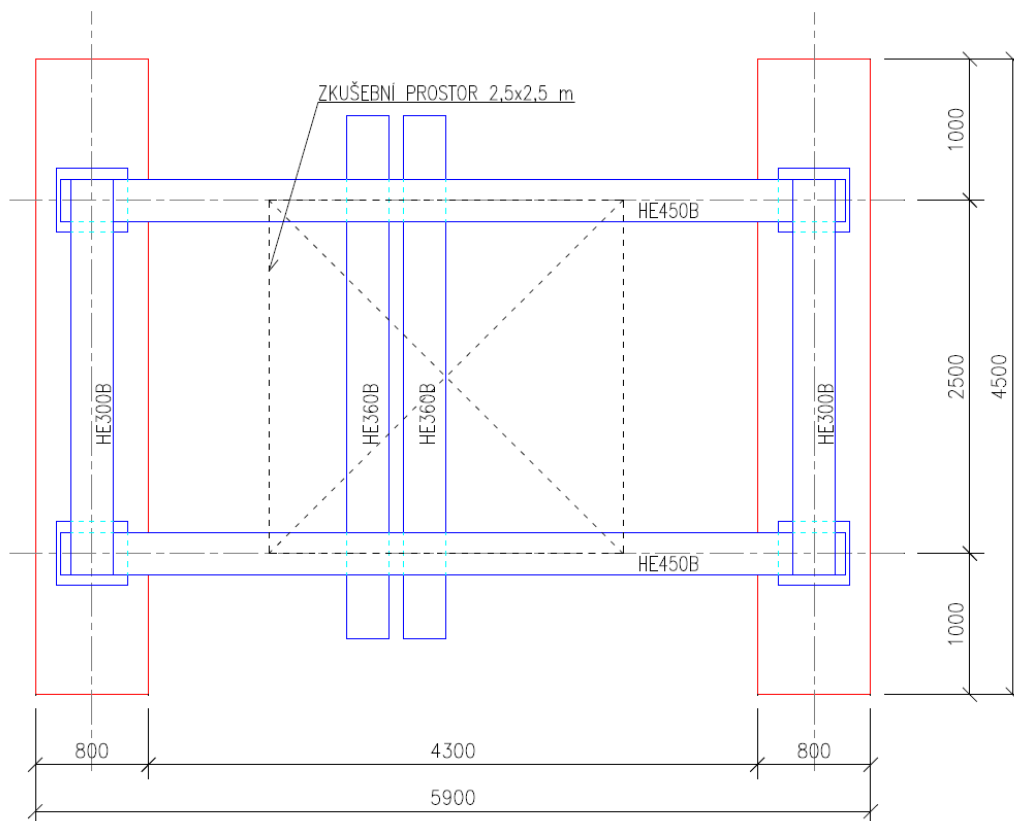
Experimentální konstrukce stand [zdroj: foto autor]
